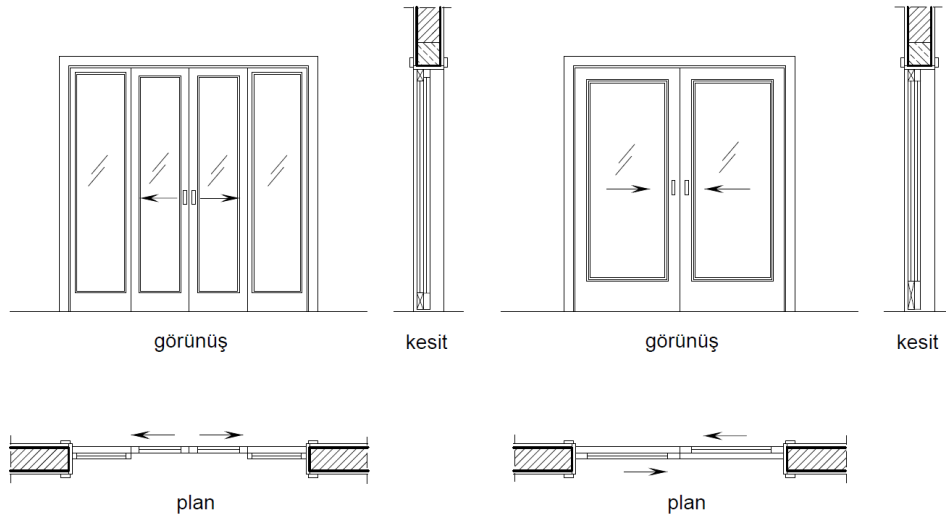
Basit kapıların plan, kesit ve görünüşleri
